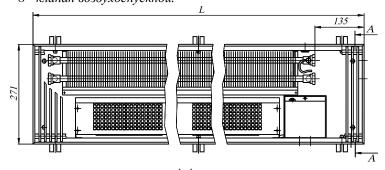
Конвектор КВК 27.11.060...300-ВК (ВТ)-П1 - короб установочный; 2 — элемент нагревательный; 3 —блок вентилятора; 4 — решетка; 5 — болты упорные; 6 — опоры, 7 — распределительная коробка (V) или блок контроллера (VK) или блок трансформатора (VT); 8 - клапан воздухоспускной.
